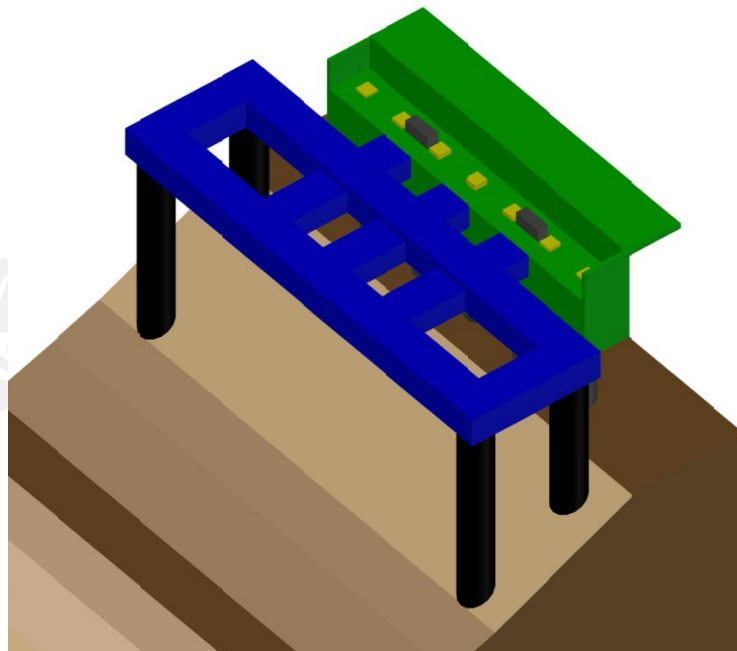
Detalle de la interconexión de la estructura auxiliar con el apoyo en la margen derecha del puente La Pigua III.
